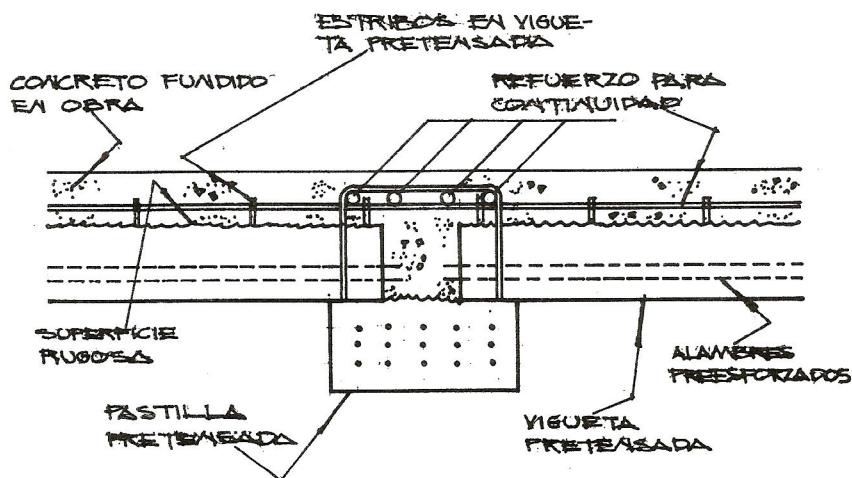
Construcción Mixta. Detalle de vigas y nervios con "pastilla" pretensada.
